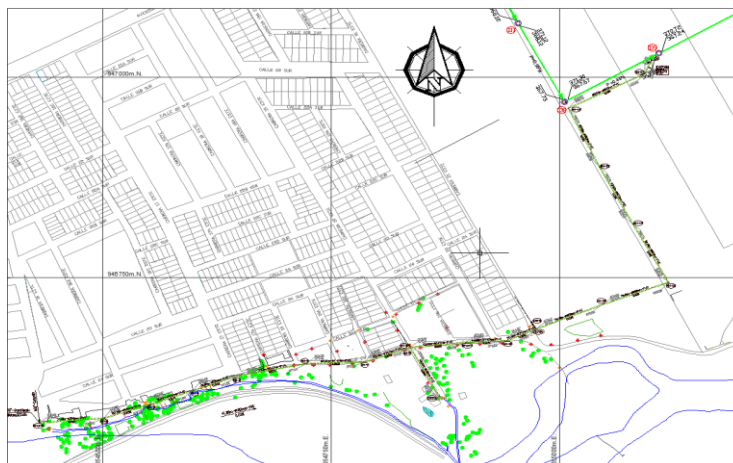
Trazado Sistema de alcantarillado sanitario
